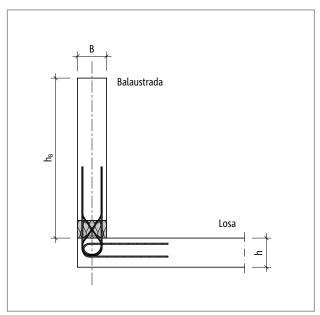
Schöck Isokorb® XT tipo A: Sistema estático
